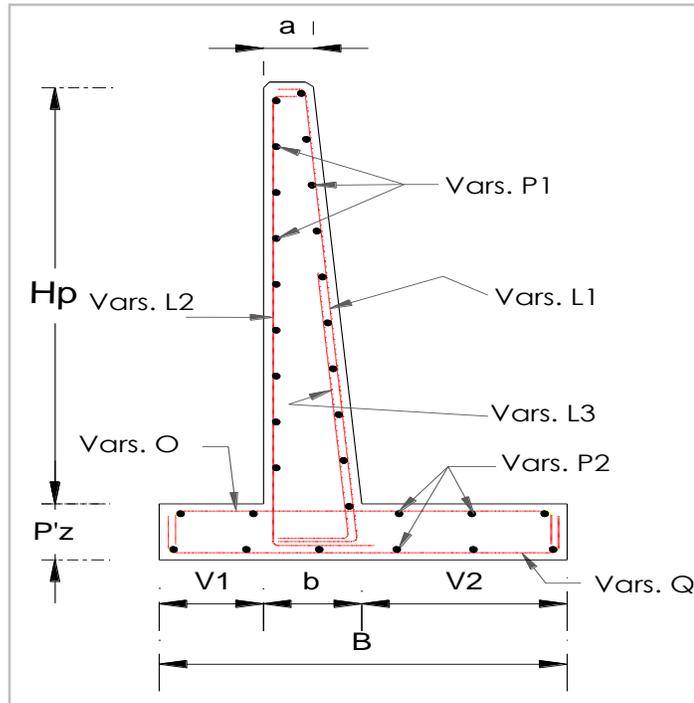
ARMADO EN LA SECCIÓN NORMAL DEL ALERO
